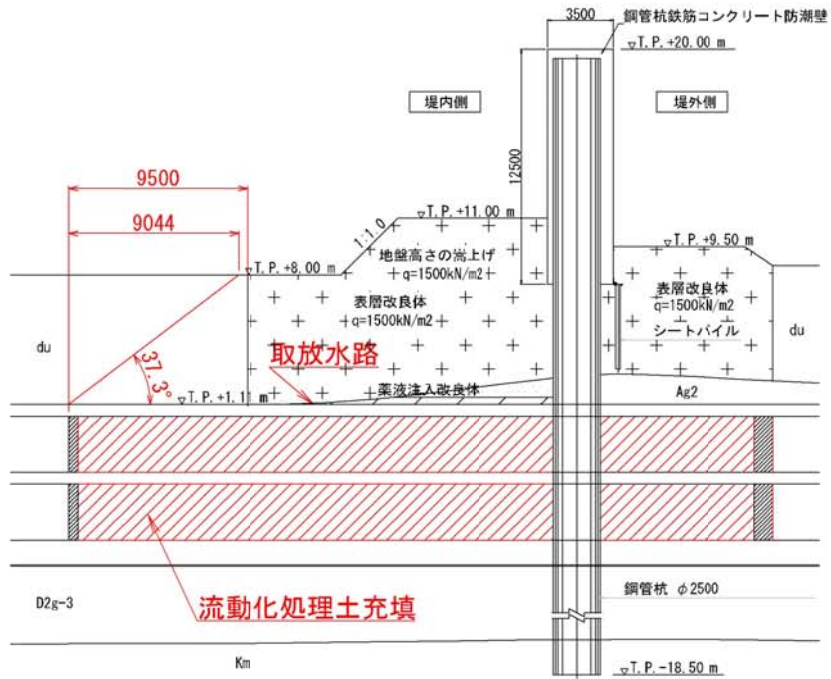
取放水路埋戻し位置断面図 (B-B断面)
